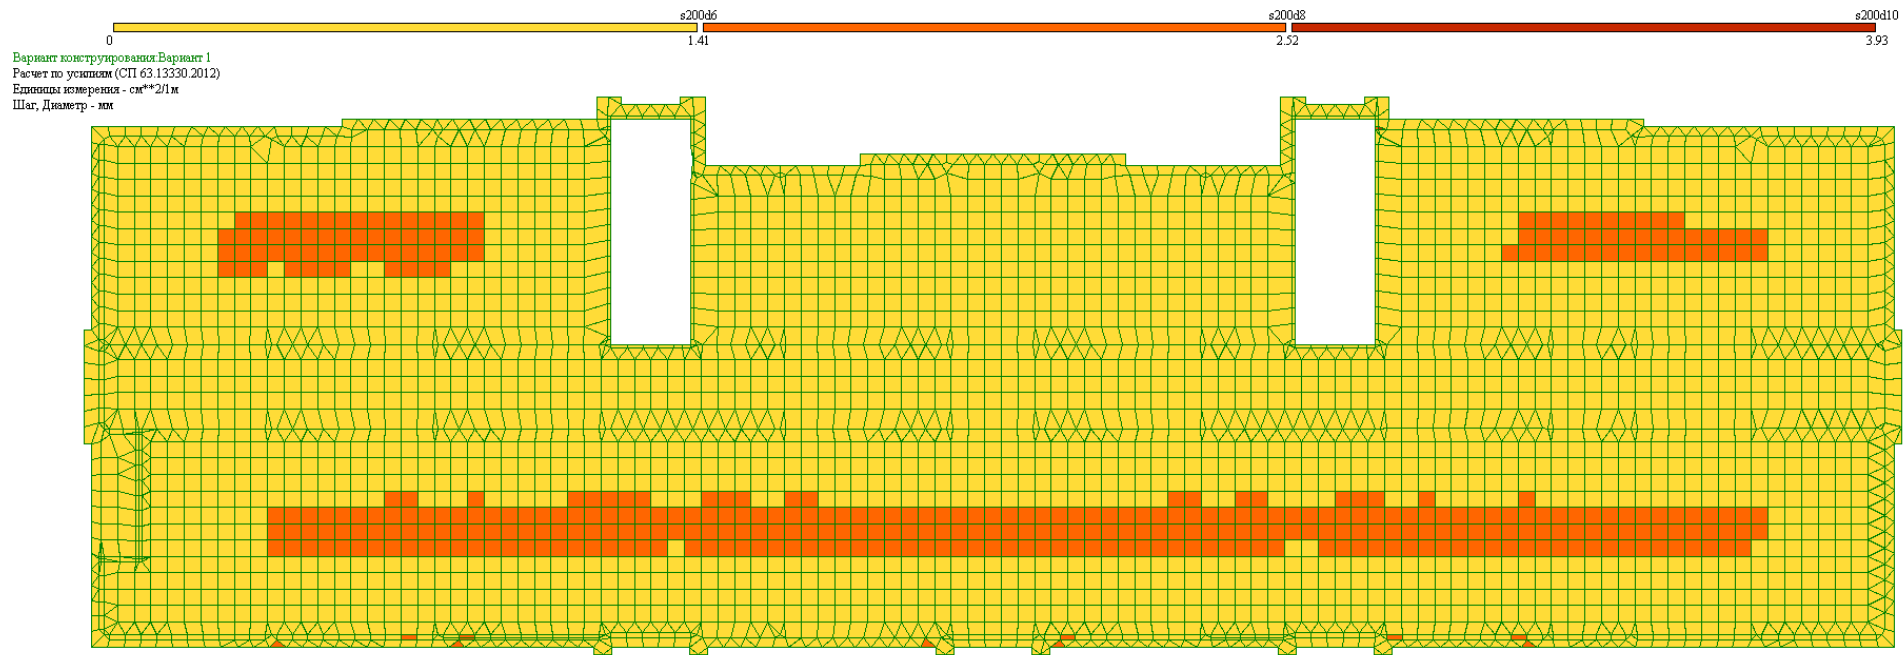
Мозаика армирования перекрытия техподполья по оси X у нижней грани
